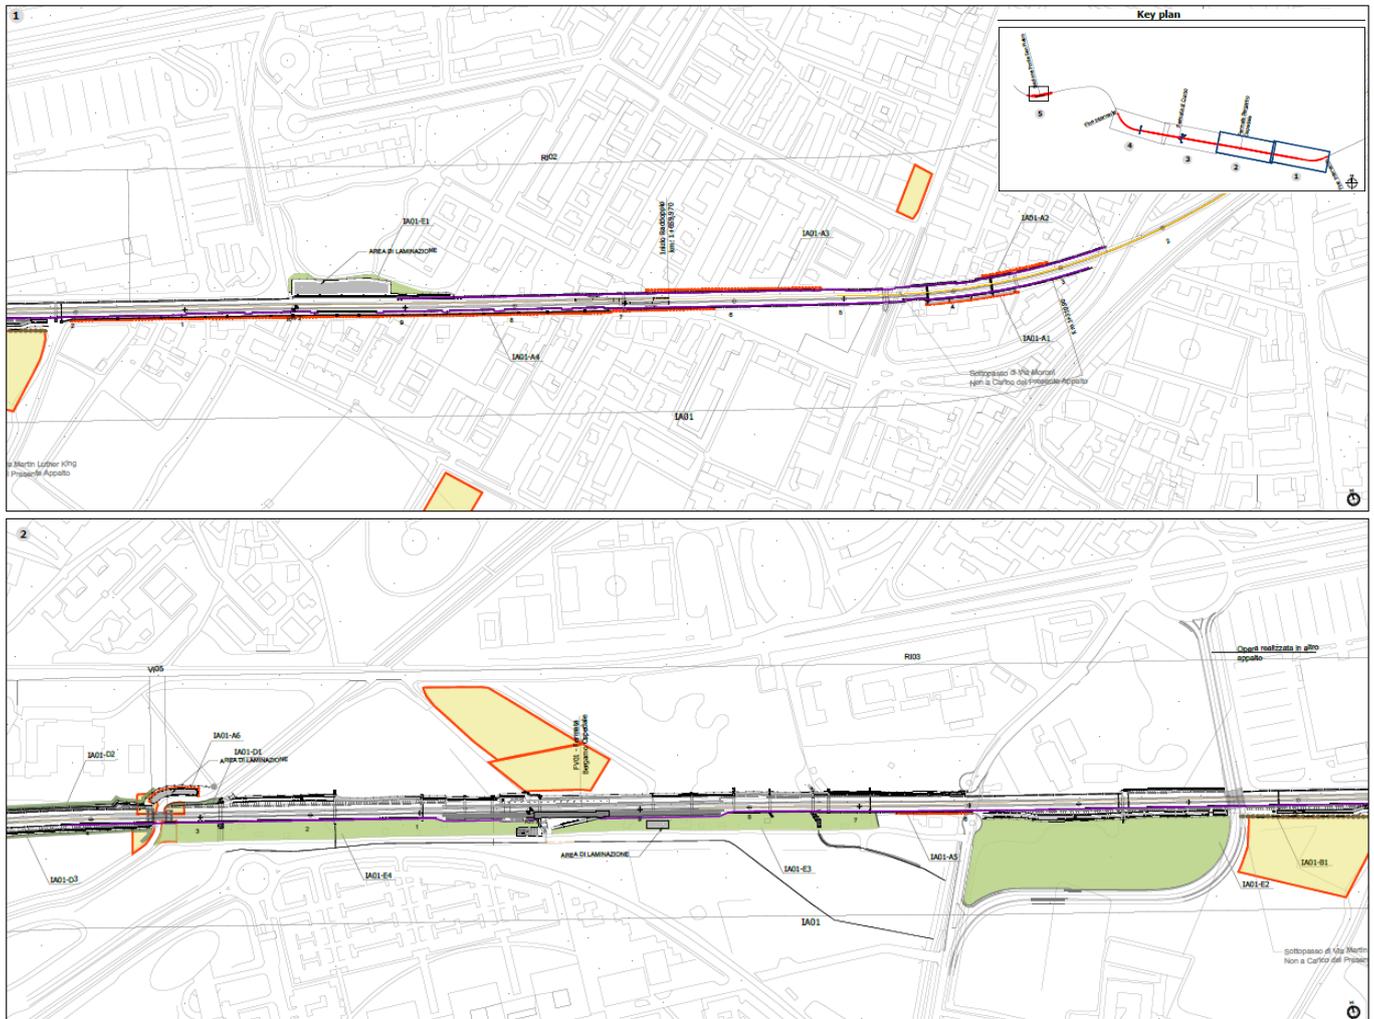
Stralcio planimetria generale degli interventi a verde per il 2° appalto
